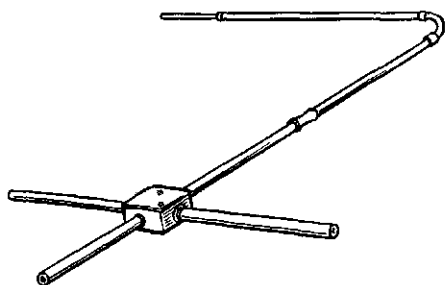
Пример прокладки изделий для электропроводок в винилпластовых трубах
